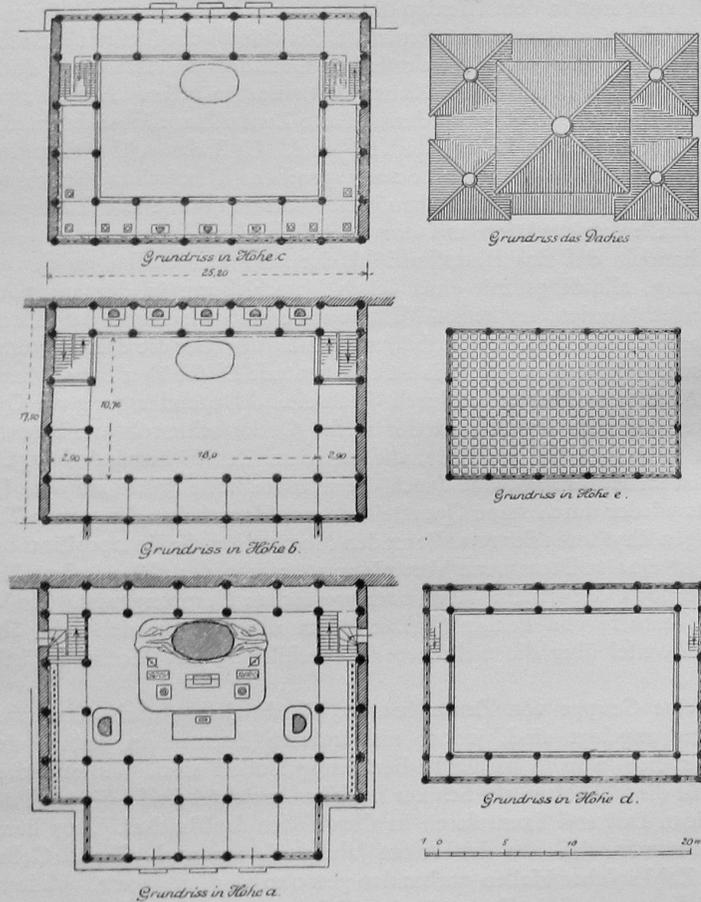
Grundrisse der Großen Halle im Ta fo sze in Jehol.
